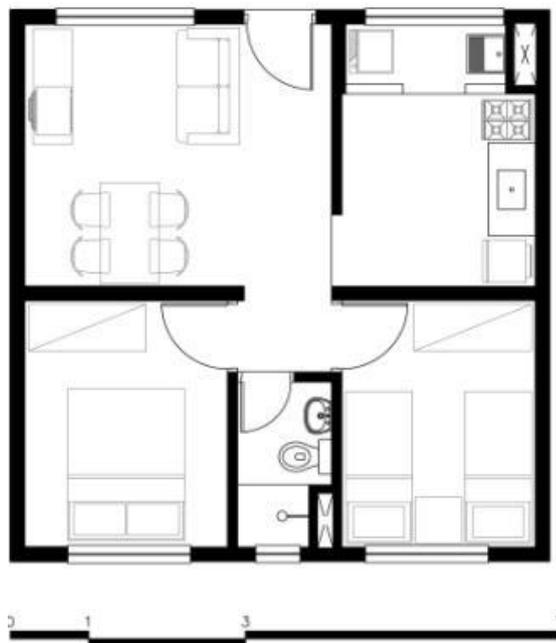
Unidade demonstrando no número de pessoas prevista em projeto para habitar no conjunto. Apresentando edifícios com Térreo mais quatro pavimentos, dispensando a utilização de elevadores. Fonte: INFOHABITAR (2010)
